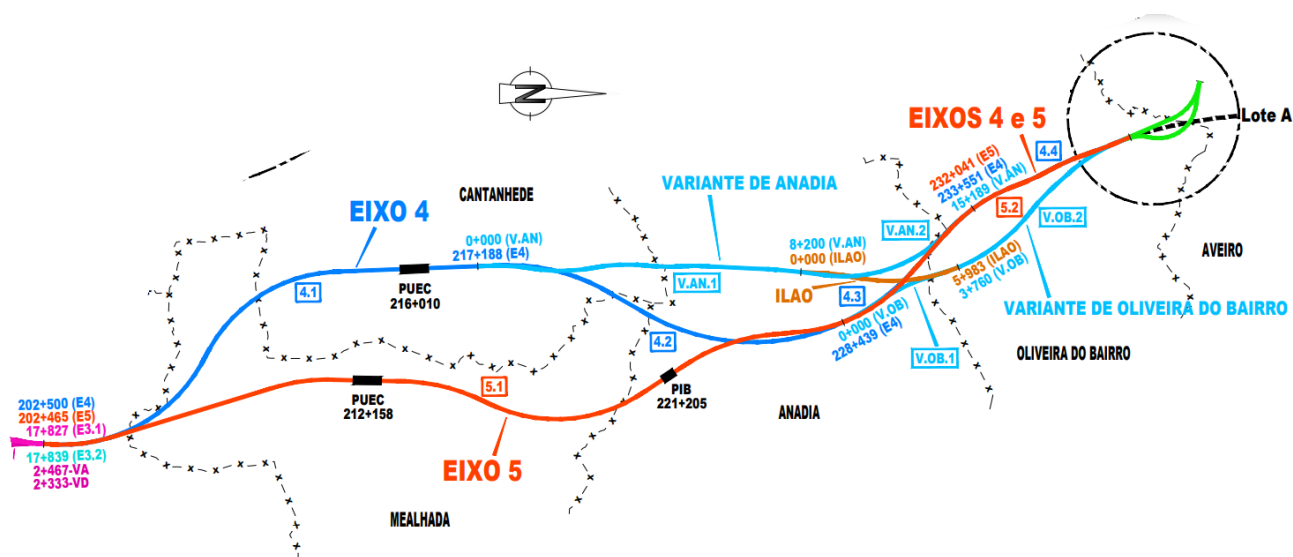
Esquema de alternativas de traçado – Trecho Norte
